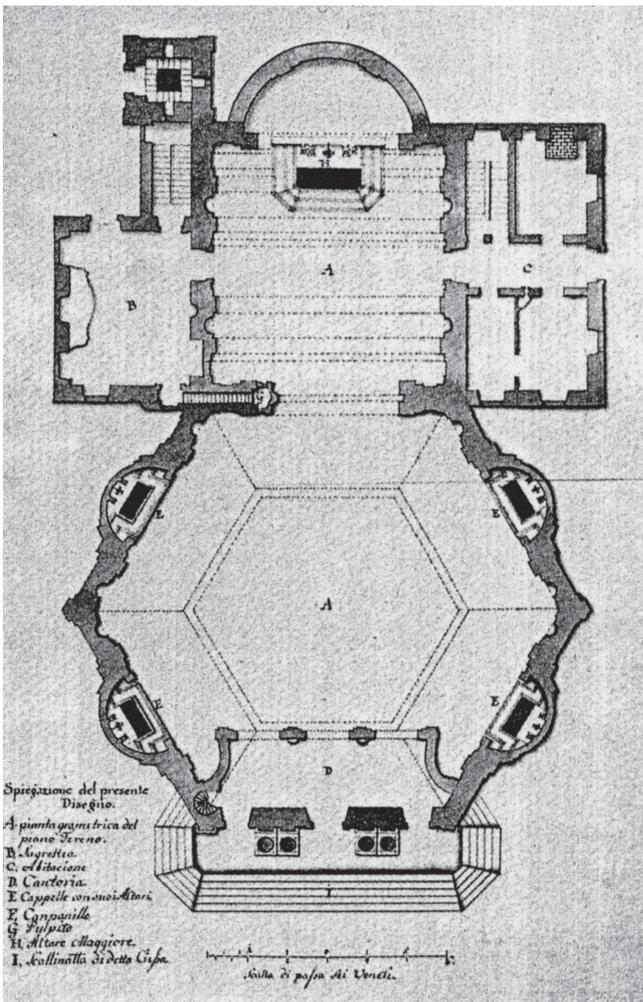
Pianta della chiesa settecentesca. Trieste, Archivio di Stato.
